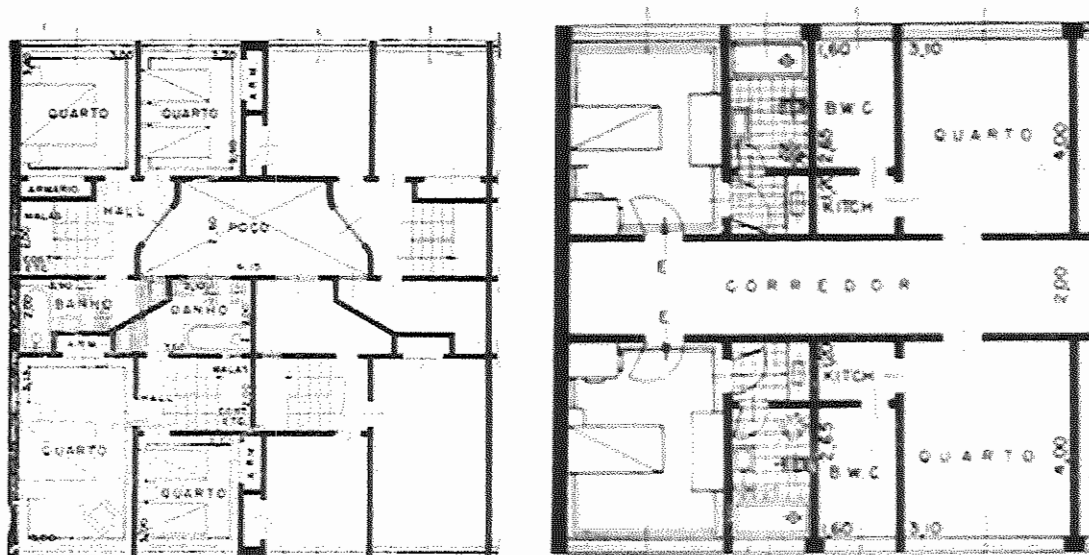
Plantas dos apartamentos do Conjunto Japurá
